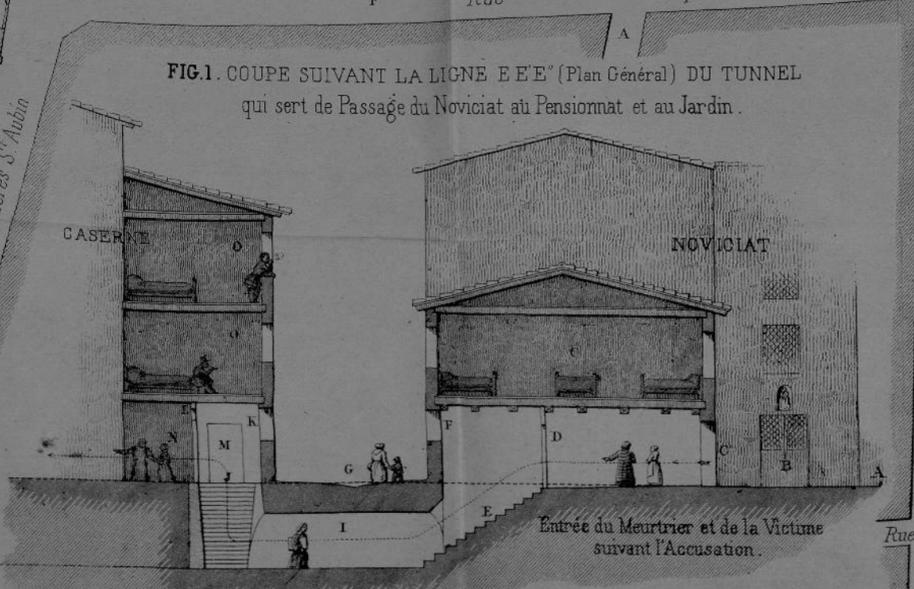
COUPE SUIVANT LA LIGNE E E' E' (Plan Général) DU TUNNEL qui sert de Passage du Noviciat au Pensionnat et au Jardin.
